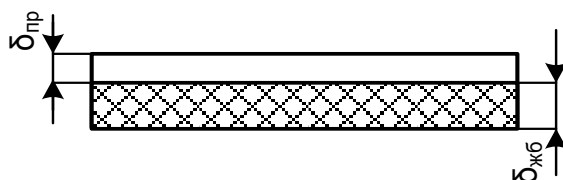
Эквивалентная конструкция многopустотной железобетонной плиты
